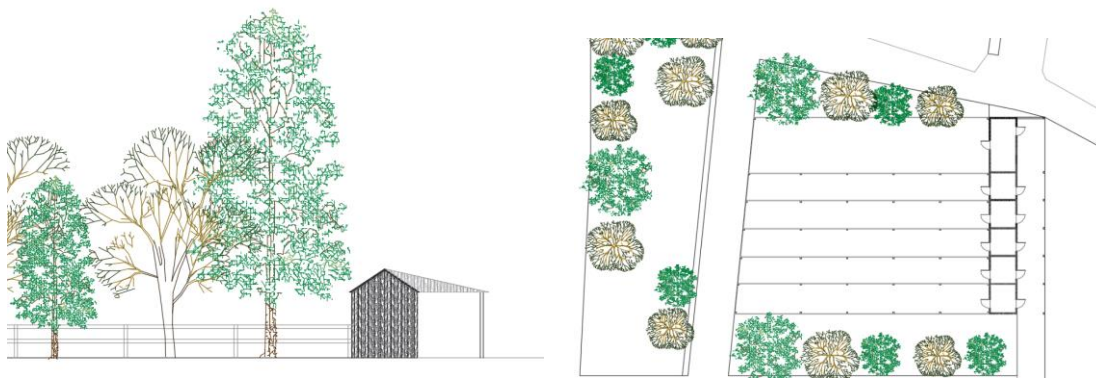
Esquema do Alçado Sul e planta do Estábulo
